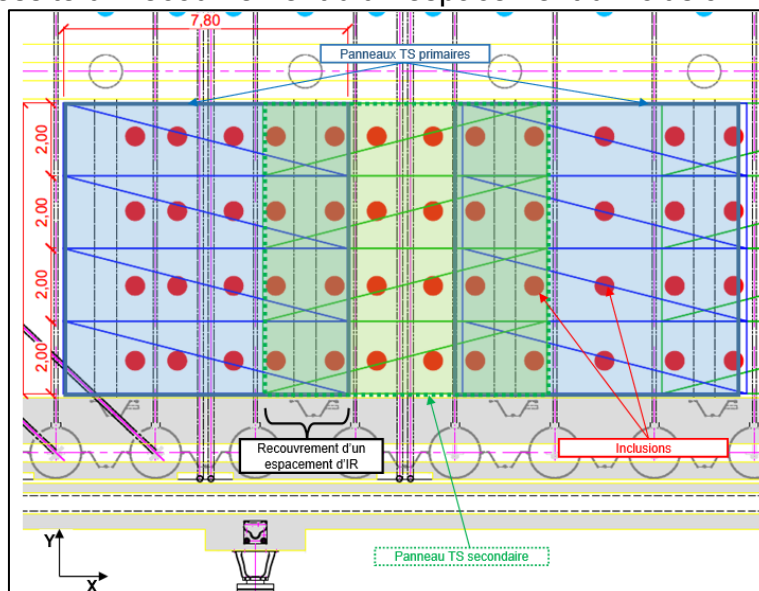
Vue en plan du calepinage du renforcement par treillis soudé (sens X)
